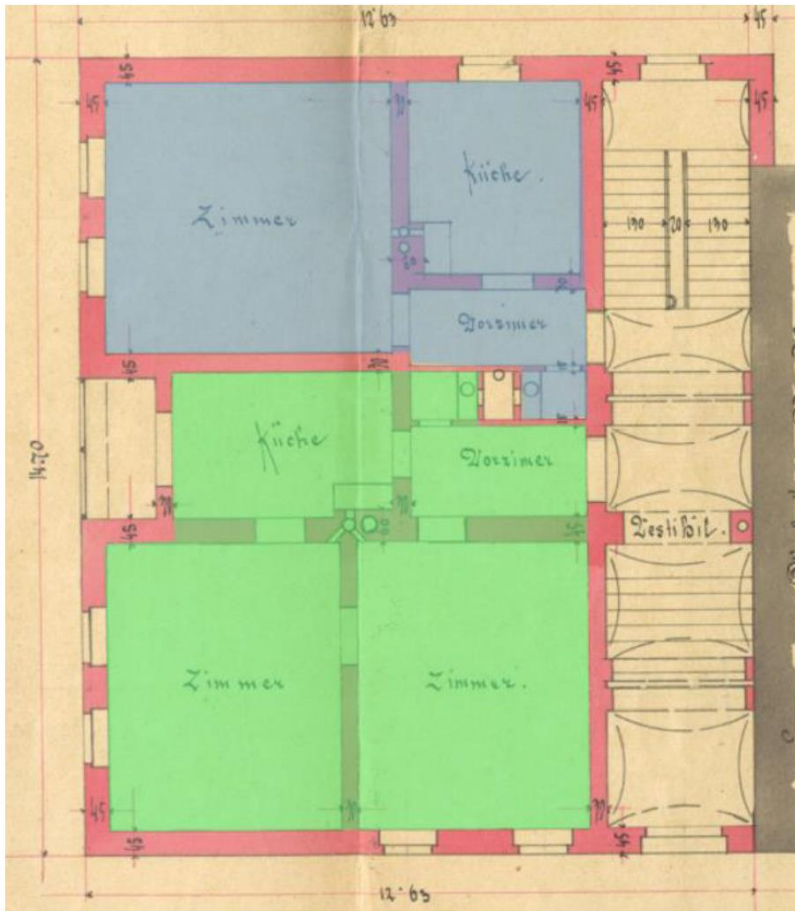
Grundriss eines Mietshauses im Hochparterre⁶⁶
